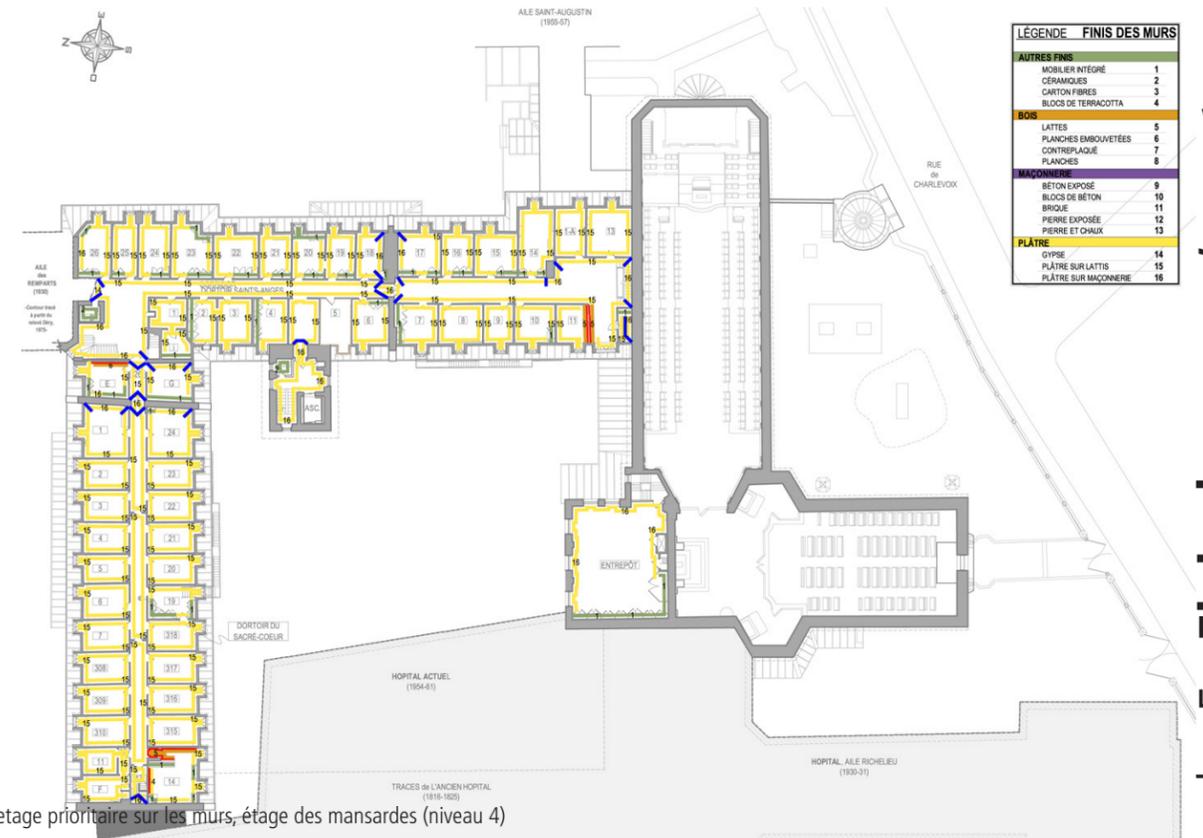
Plan de curetage prioritaire sur les murs, étage des mansardes (niveau 4)
